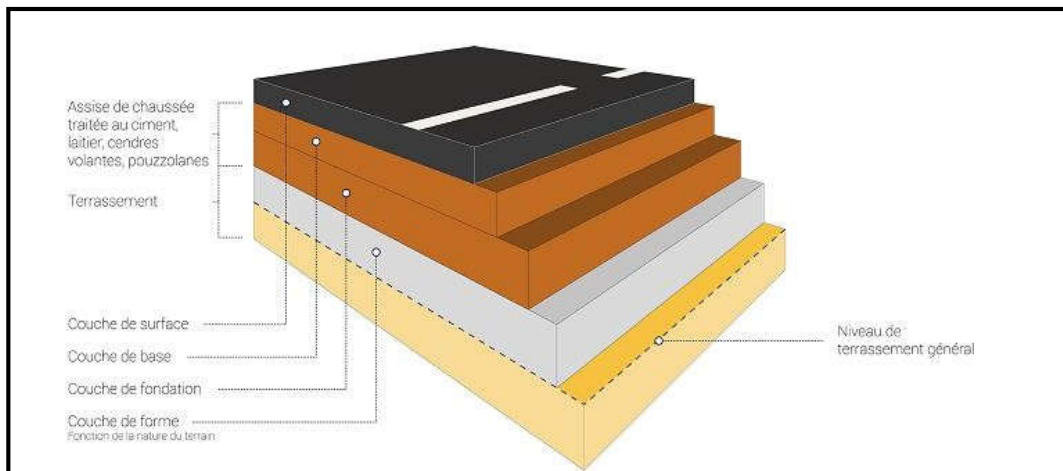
Structure type d'une chaussée semi – rigide [37]
